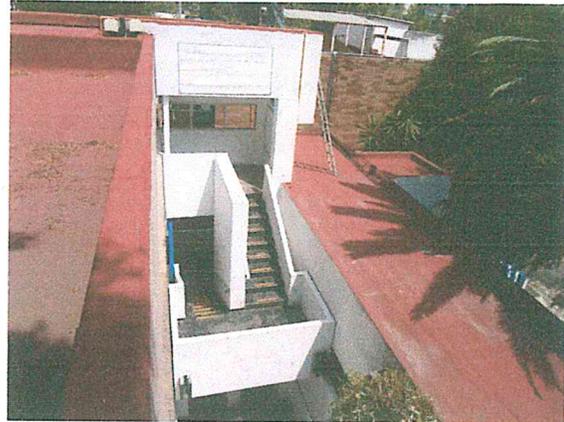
Techumbres y escaleras de concreto armado, en buen estado estructural.
